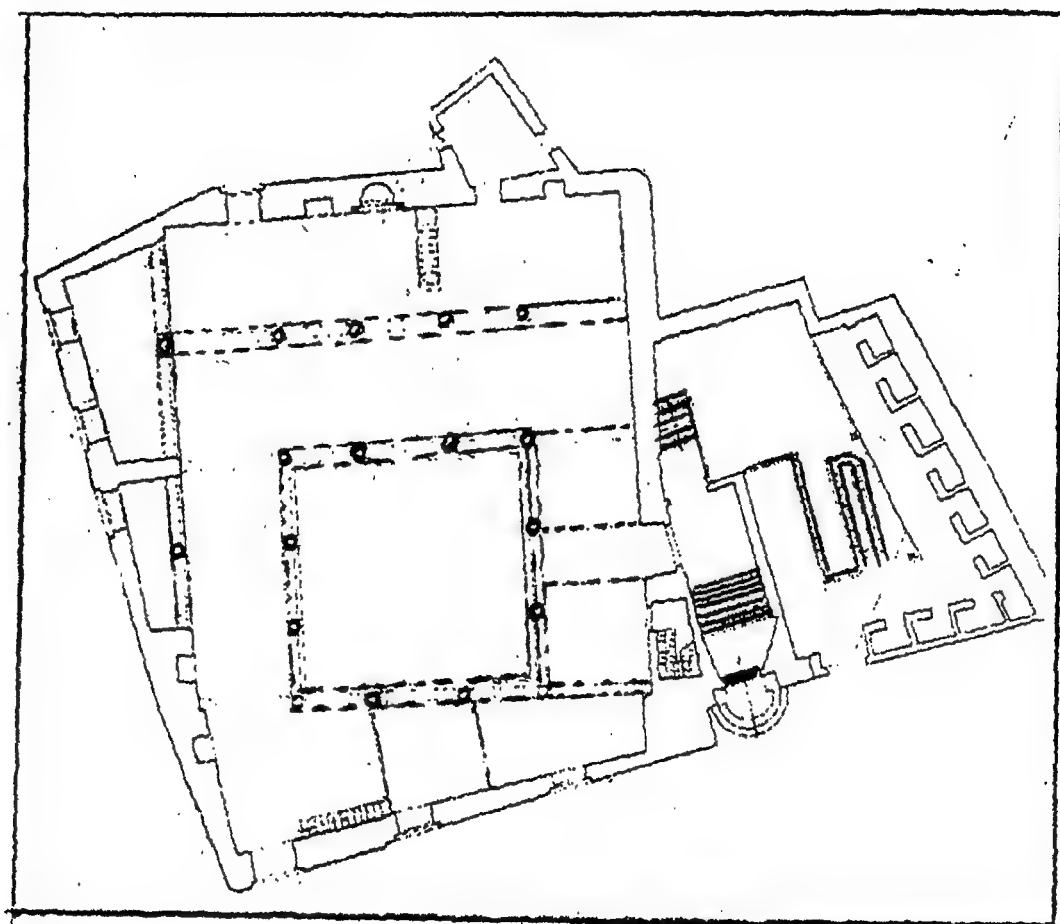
مسقط أفقى لجامع محمد كتحدا مستحفظان الشهير بجامع الحبشلى.
